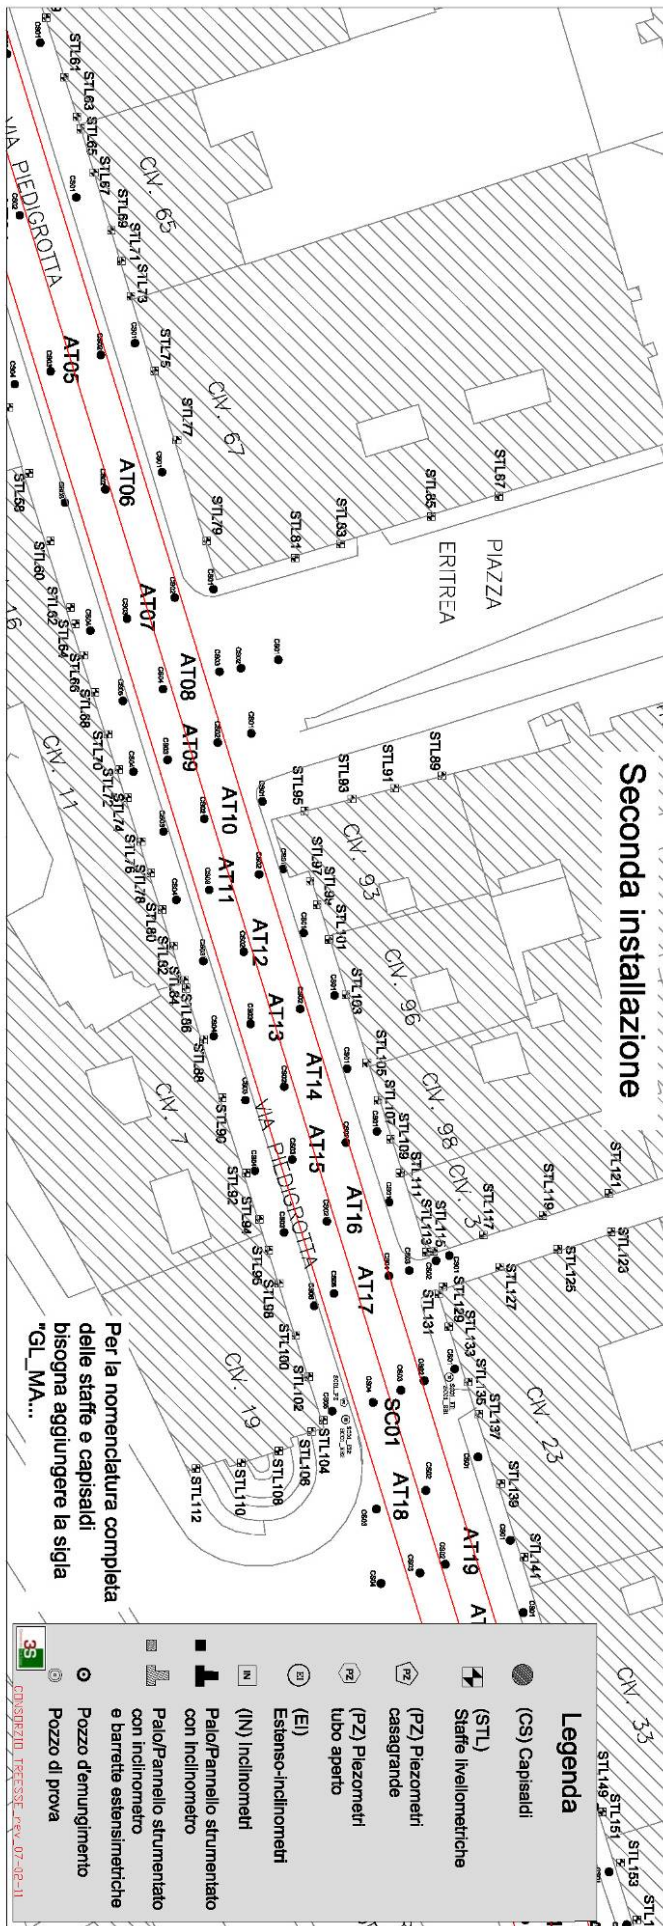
Planimetria tratta Mergellina - Arco Mirelli, raffigurante la disposizione della seconda installazione della strumentazione di monitoraggio.
